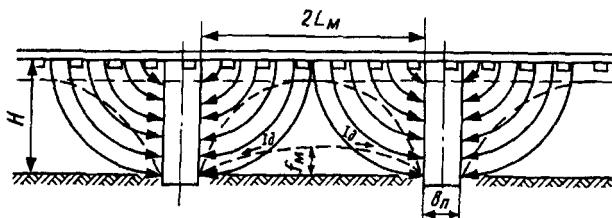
Расчетная схема поперечных прорезей для осушения земляного полотна
